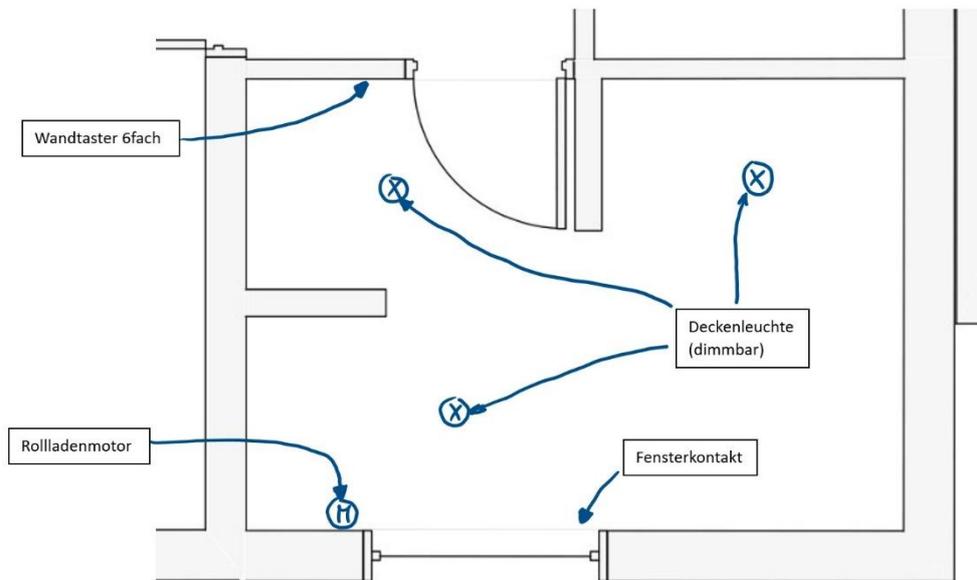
Grundriss Badezimmer mit Geräten
